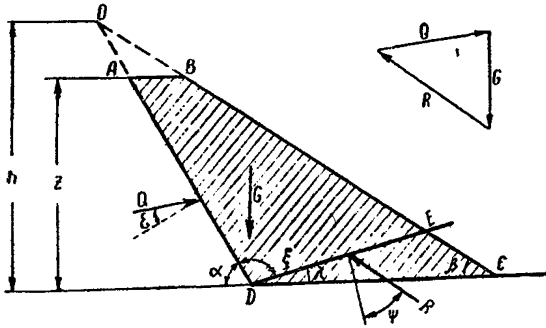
Схема к расчету устойчивости наружных призм намывной плотины с ядром
